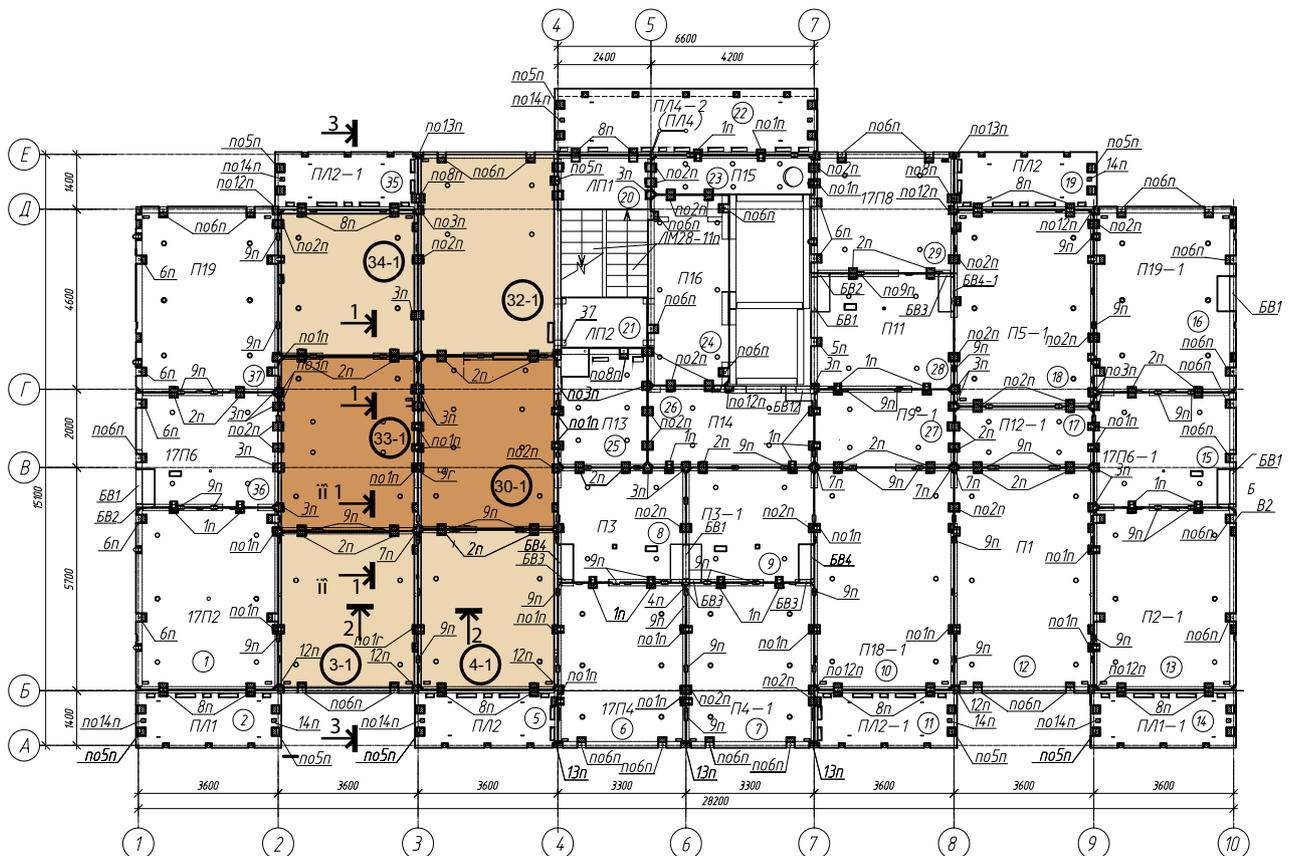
Монтажная схема плит перекрытий базовой блок-секции с многопролетными неразрезными сборно-монолитными поперечными перекрытиями в осях 2–3 и 3–4
